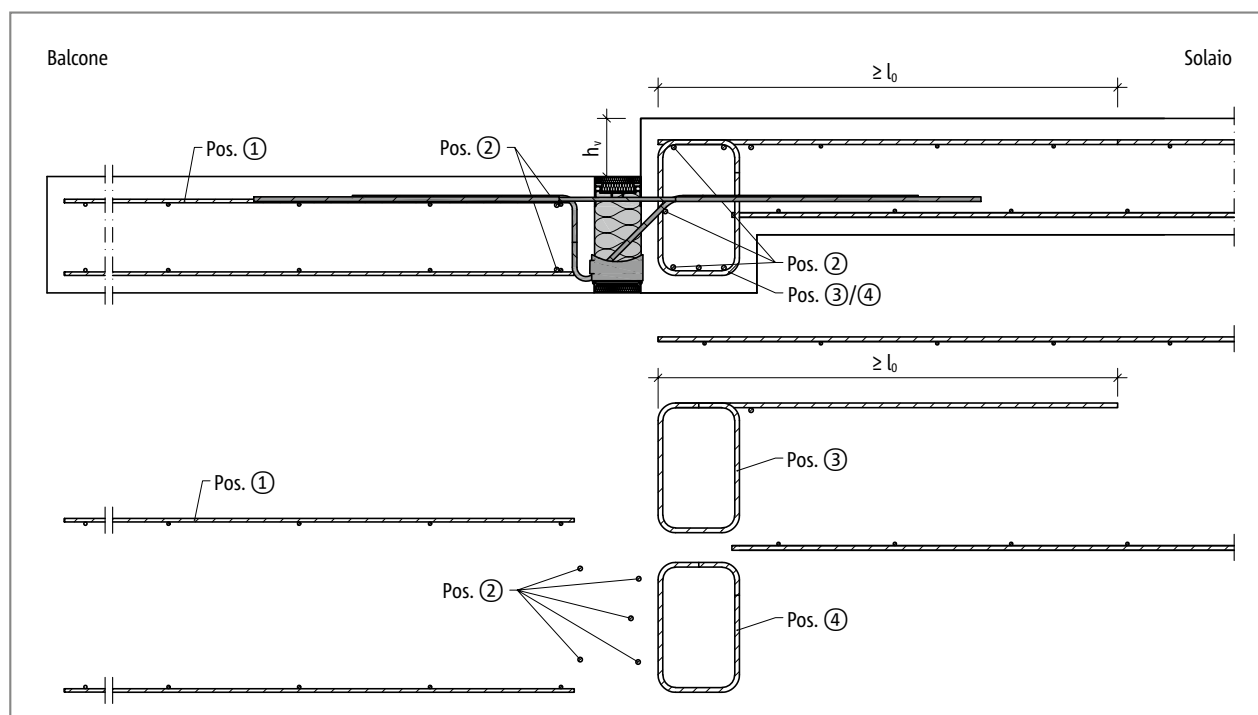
Schöck Isokorb® T tipo KL: armatura in opera con salto di quota ridotto
